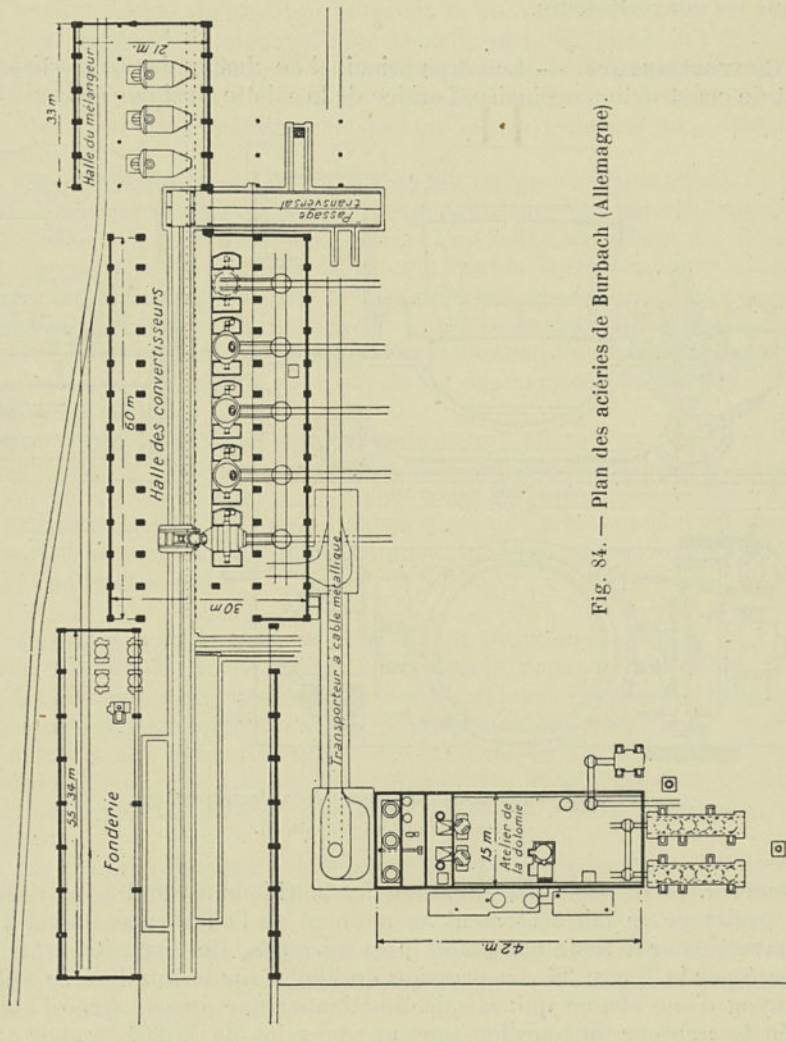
Plan des aciéries de Burbach (Allemagne).
